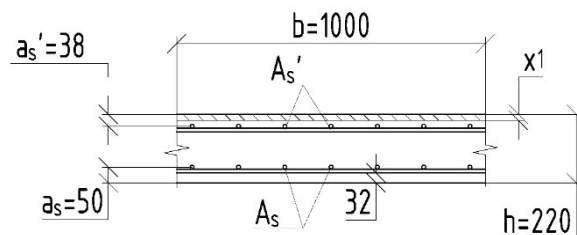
Пропонований переріз і армування умовного фрагмента плити силової підлоги.
